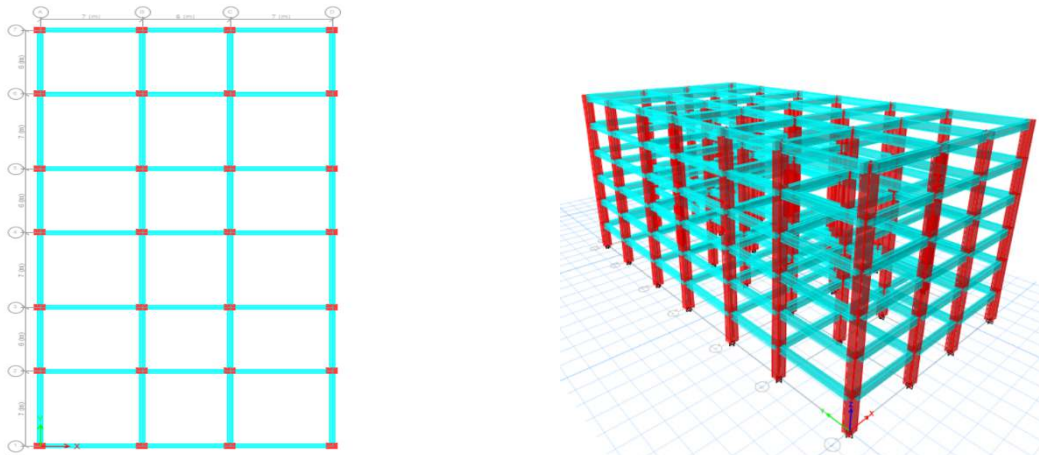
Edificio de 6 pisos regular con Columnas y vigas con vista en planta y 3D.
